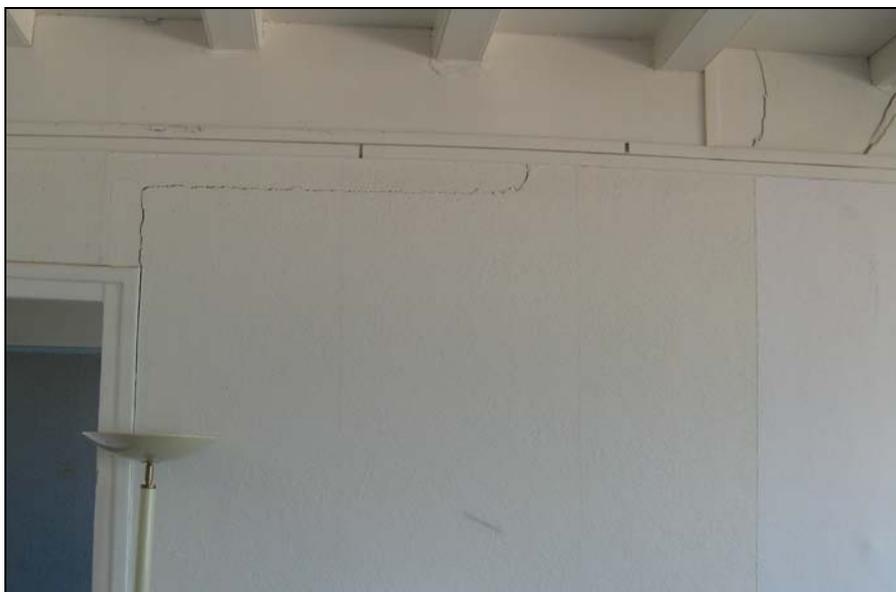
Fissure sur la façade donnant sur la falaise (Ouest).
